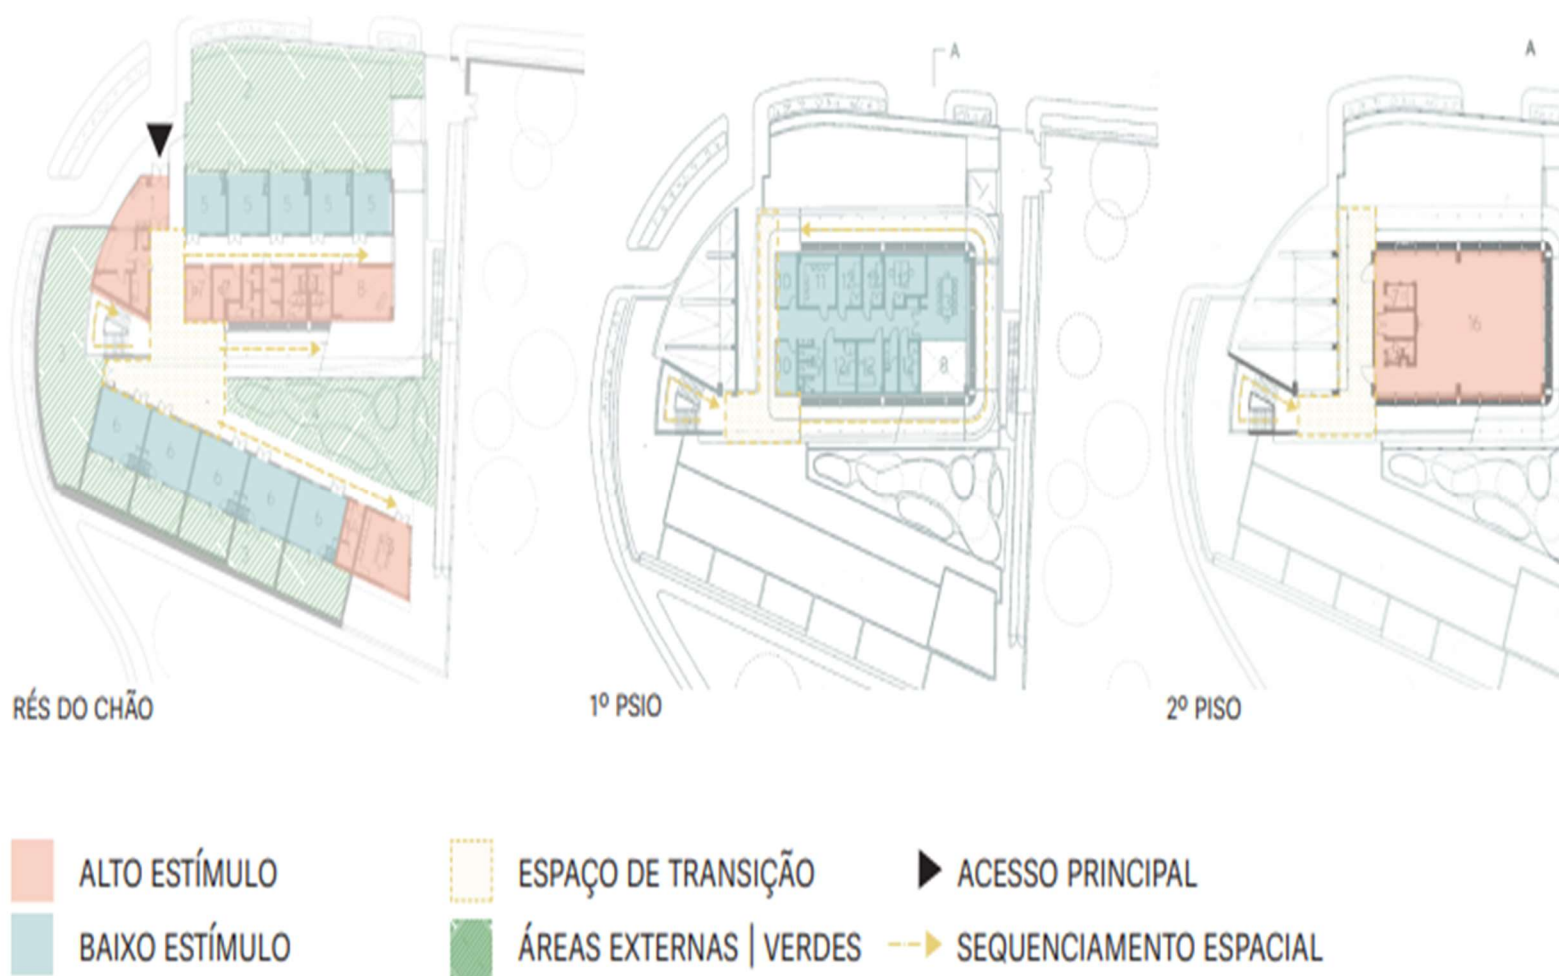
Plantas baixa 1º pav. da escola FAVA, sem escala.
